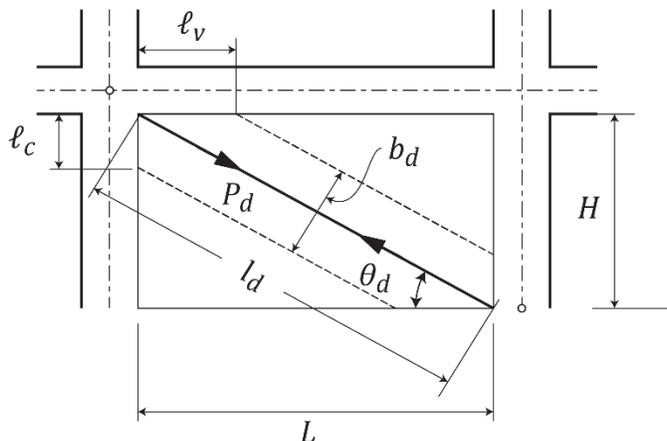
a) Geometría de la diagonal equivalente; b) Geometría de un muro diafragma
